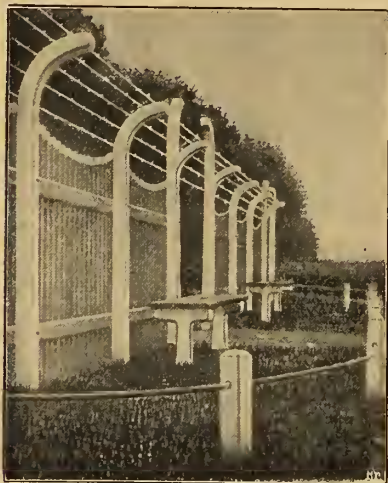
Bretterzaun mit gekrümmten Drtan-Betonpfoften.
